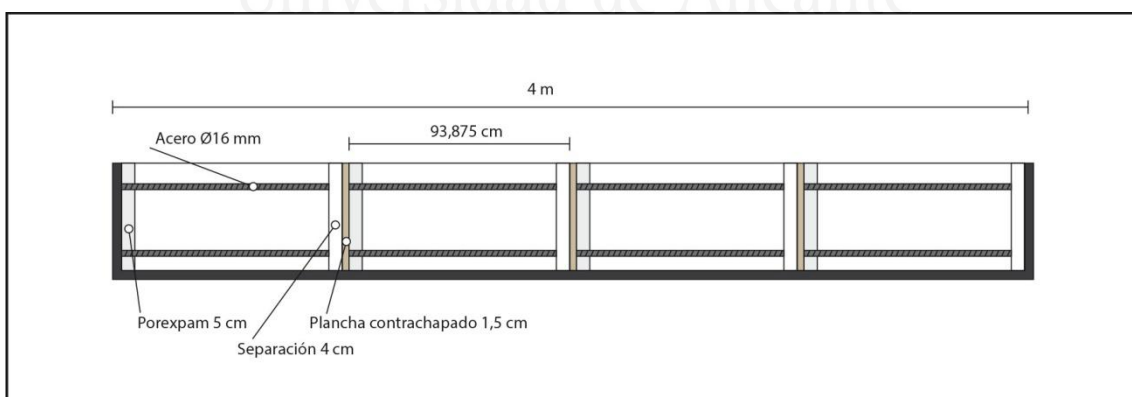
Esquema en alzado de la disposición del encofrado para la fabricación de 4 especímenes de sección rectangular 20x30 cm².
